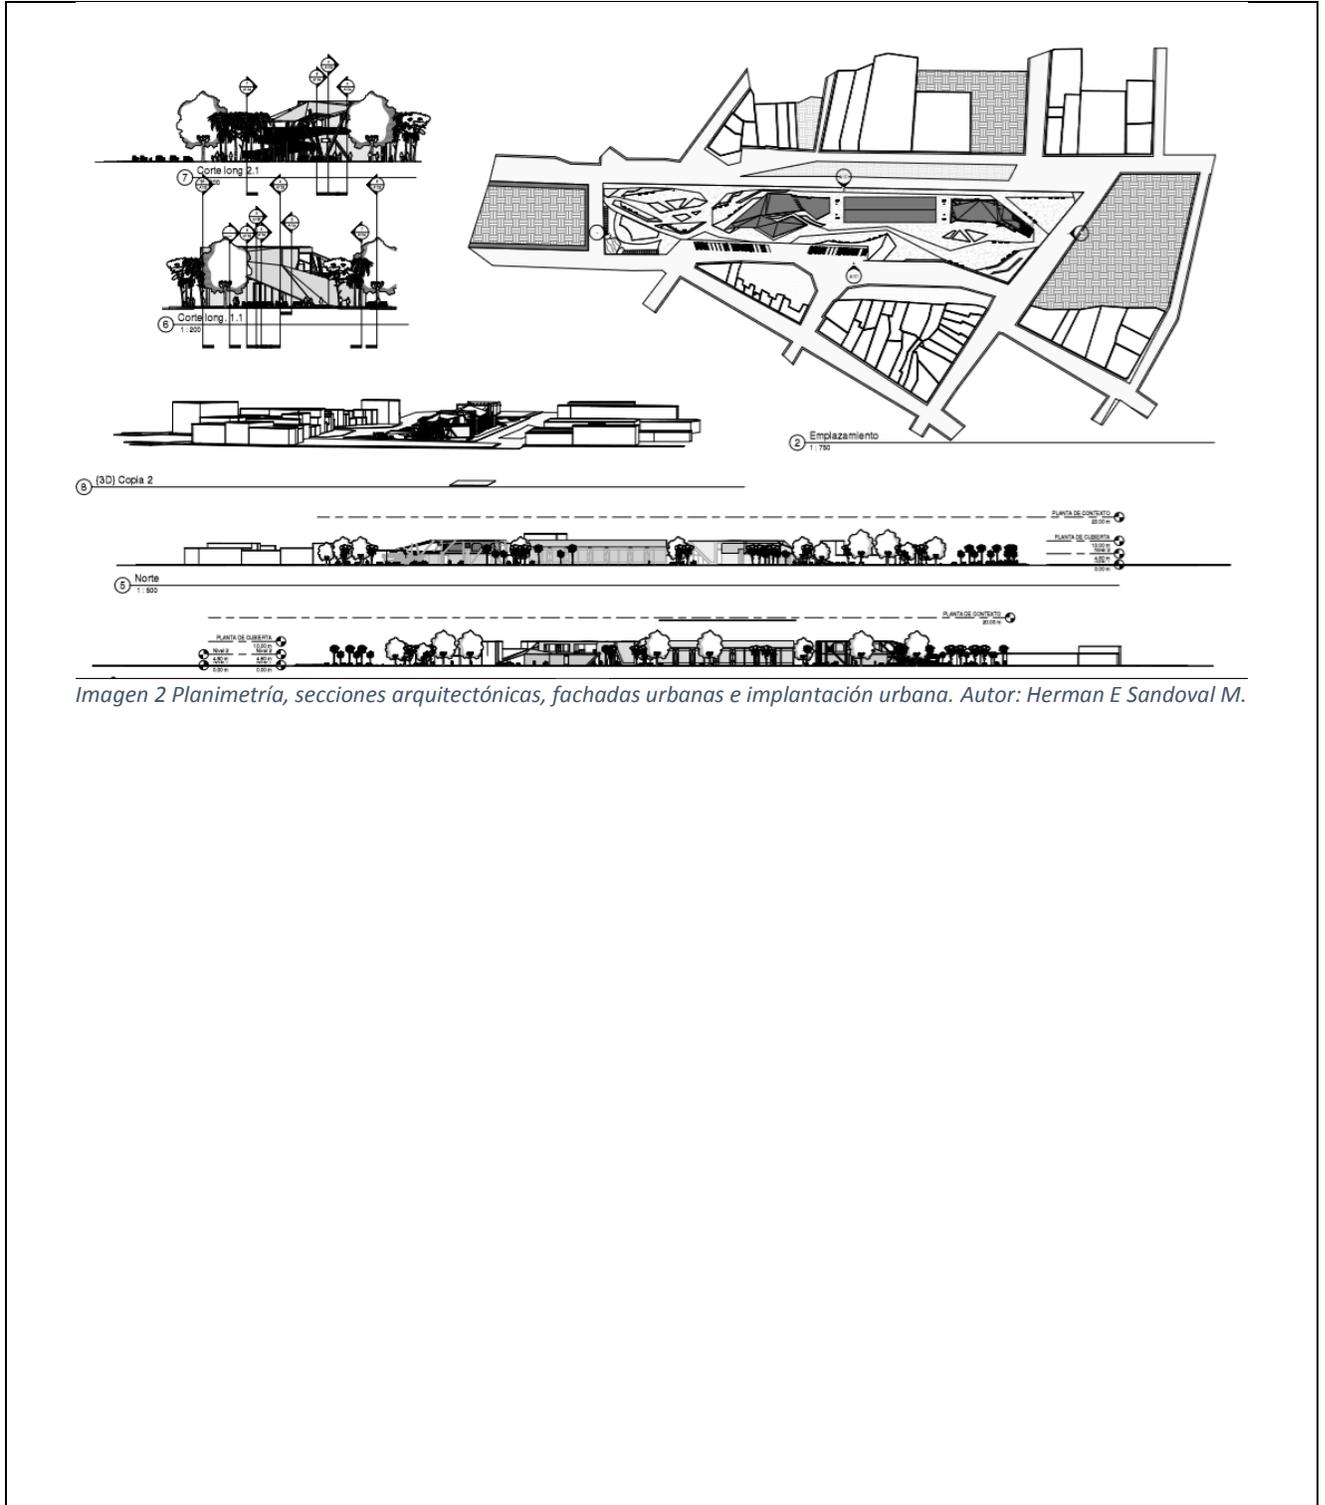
Planimetría, secciones arquitectónicas, fachadas urbanas e implantación urbana. Autor: Herman E Sandoval M.
